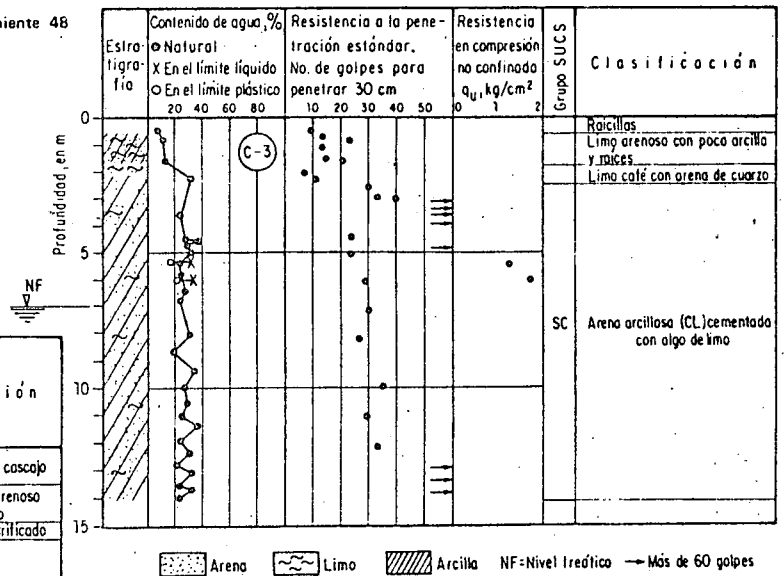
Perfil estratigráfico. Estudio 38. Planta Yeso Panamericano
